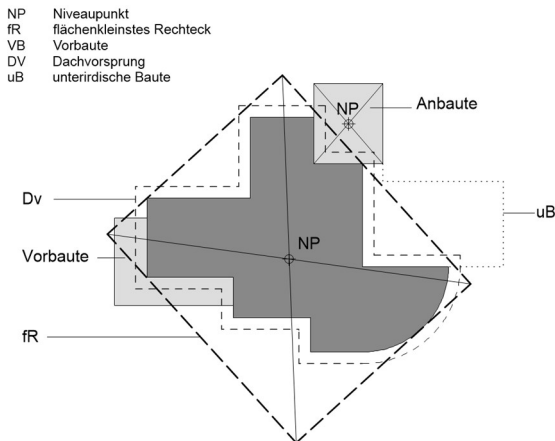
Flächenkleinstes Rechteck für Niveaupunkt über massgebendem Terrain
